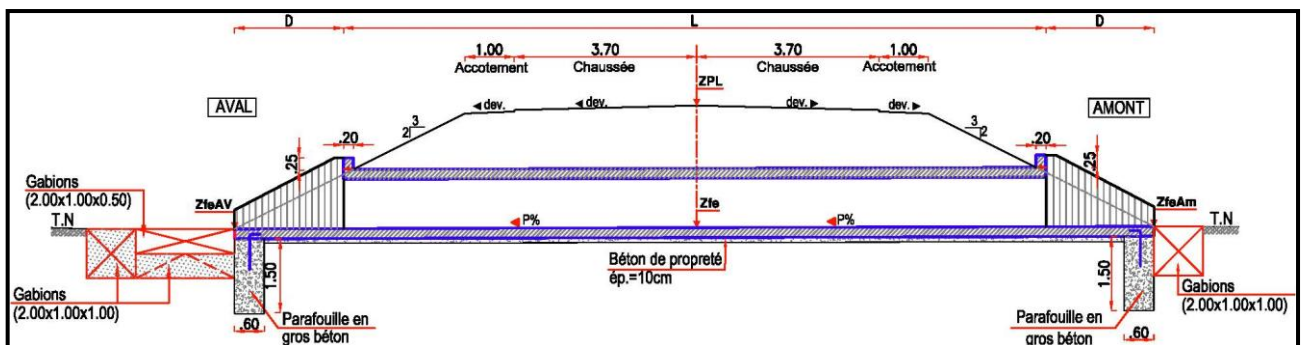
COUPE LONGITUDINALE TYPE D'UN DALOT AU NIVEAU DE LA ROCADE
